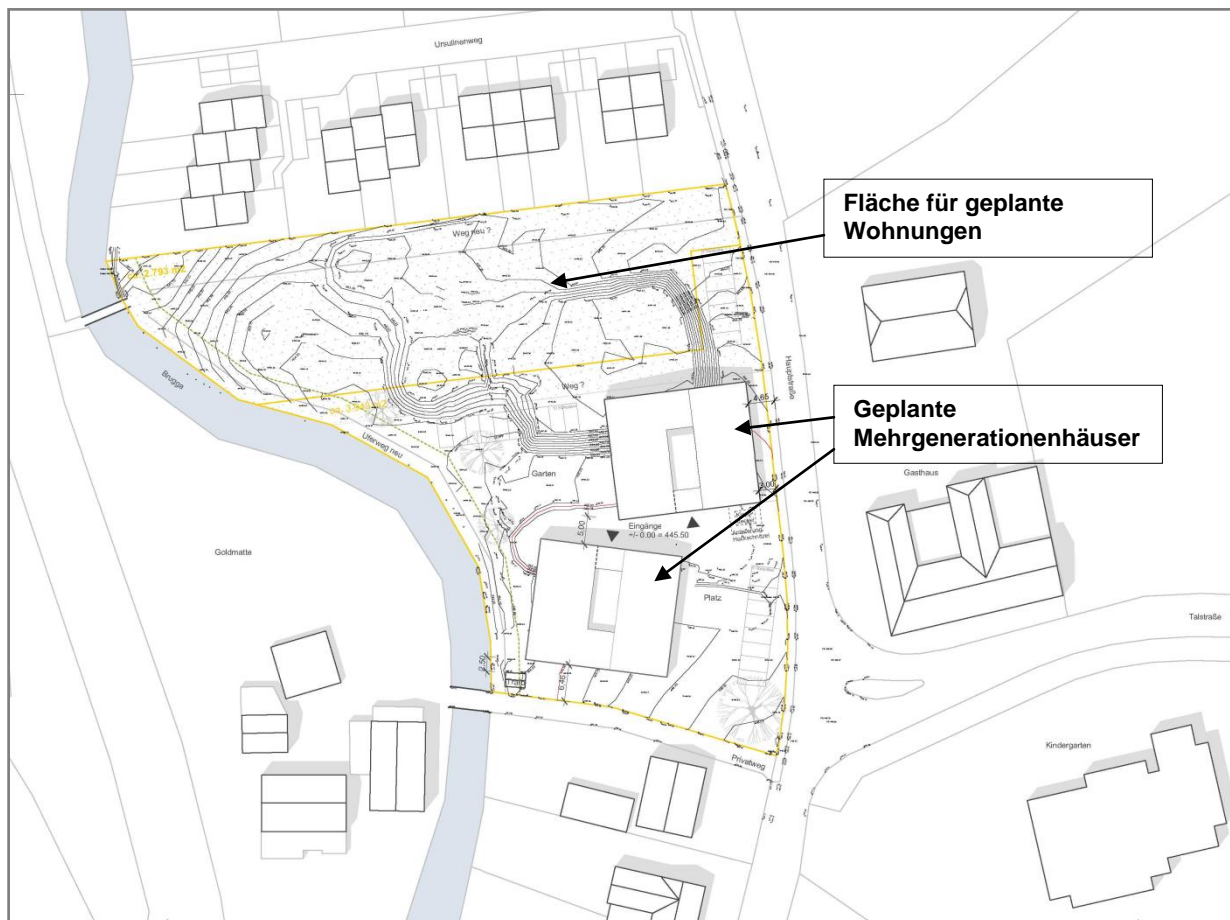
Lageplan zur im Plangebiet vorgesehenen Bebauung /18/
